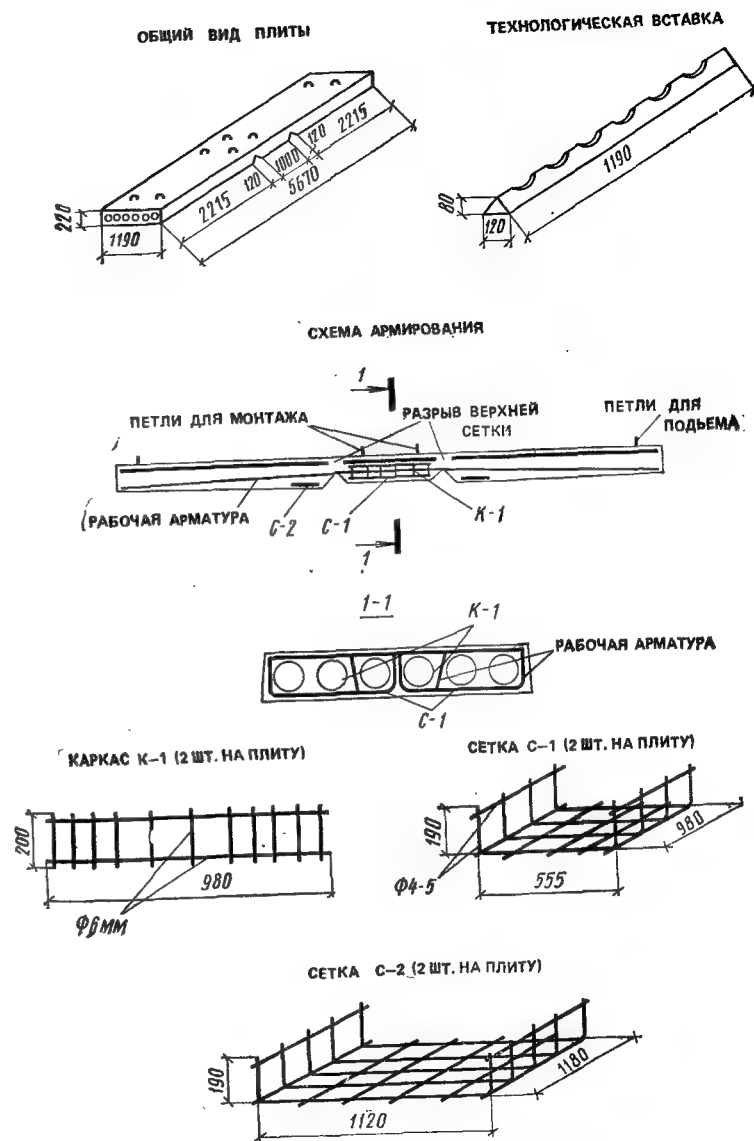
Общий вид и схема армирования трехзвенной плиты, изготавливаемой в опалубке пустотелых панелей
